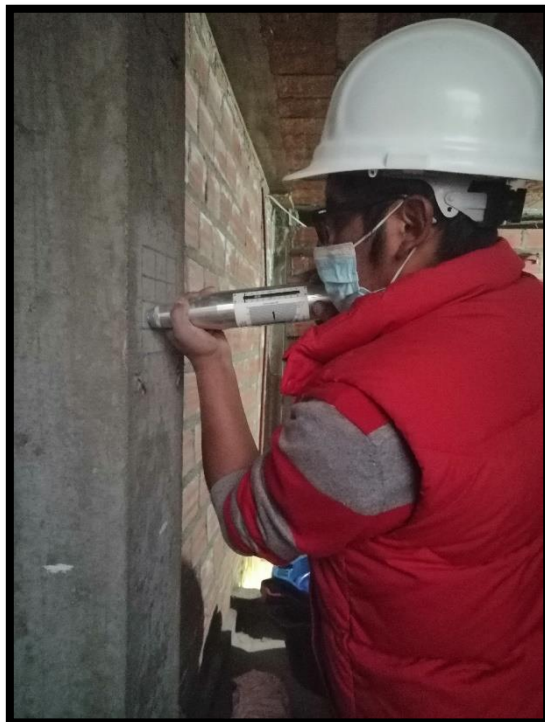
y 10: Tomando medidas para determinar áreas con fisuras en muros.
